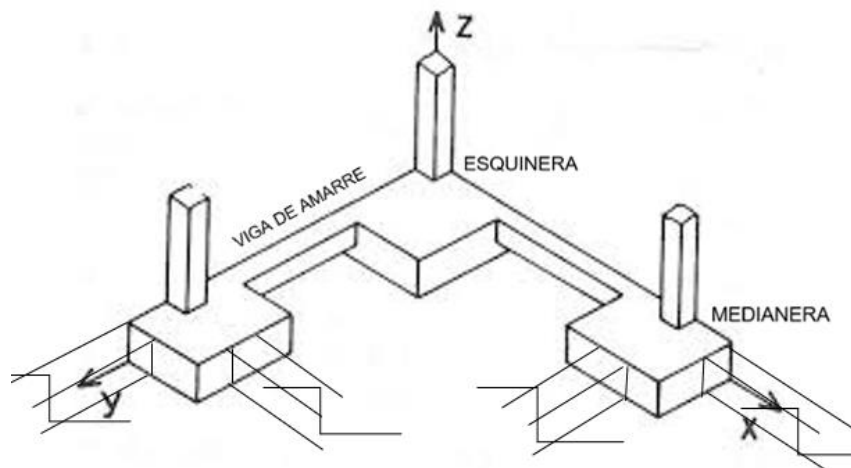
Zapata aislada medianera y esquinera con vigas de amarre o centradoras perpendiculares
